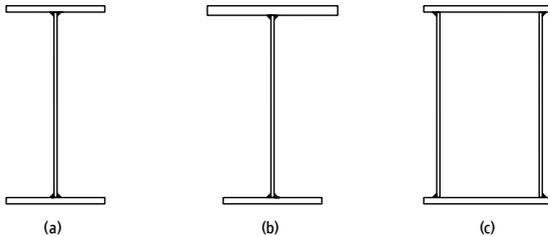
Exemple de profilés reconstitués par soudage
